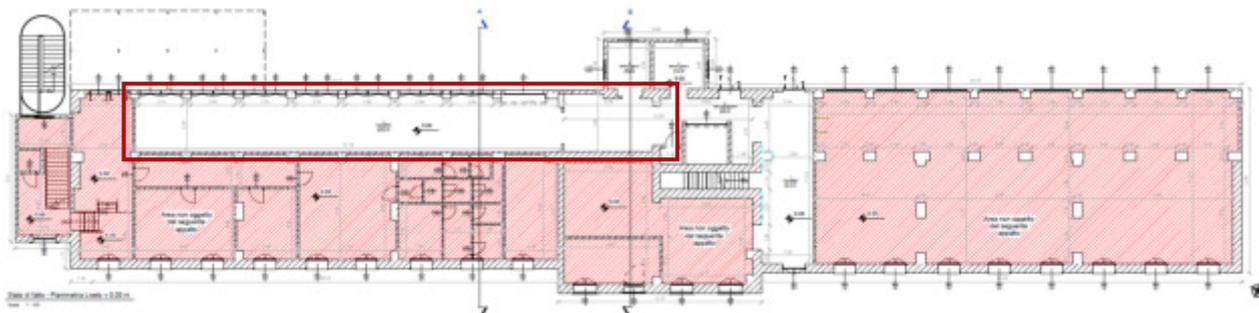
Stato di fatto – Planimetria Livello +0,00m
